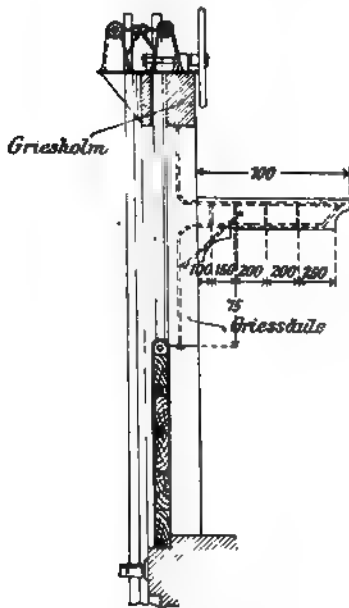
Laufbrücke eines beweglichen Wehrs.
